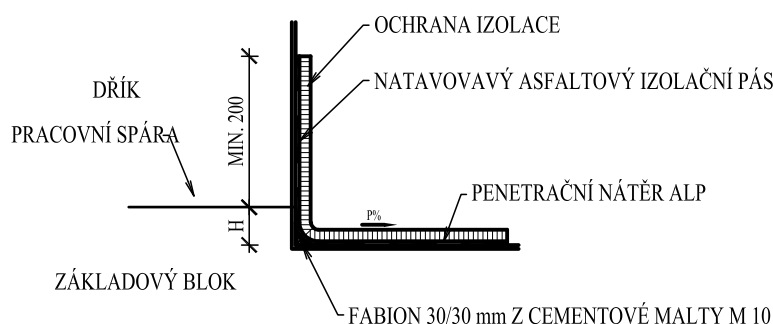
DETAIL TĚSNĚNÍ PRAC. SPÁRY MEZI ZÁKLADEM A DŘÍKEM OPĚR
